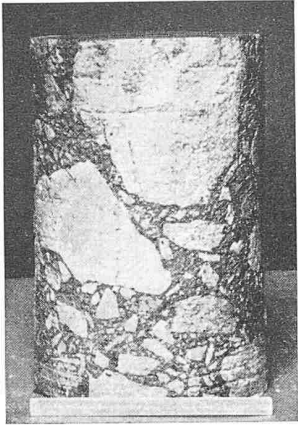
Kernbohrung aus dem Staumauerbeton mit 200-mm-Korn
